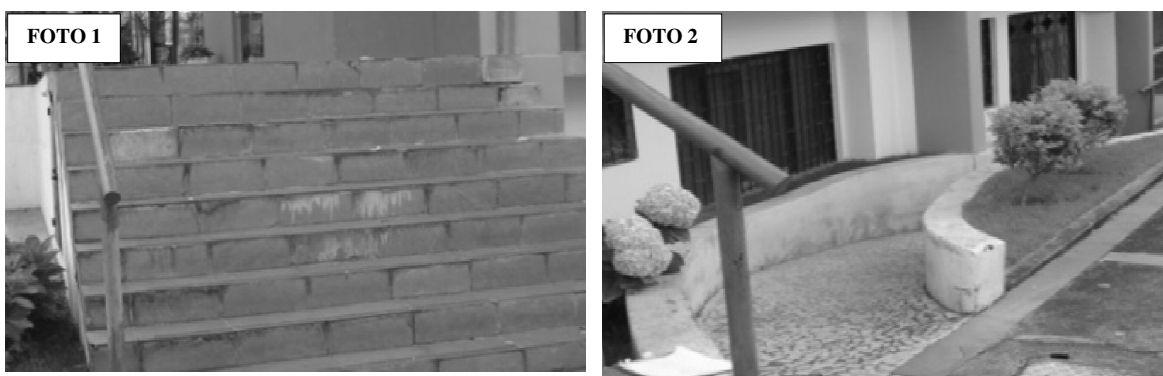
Foto 1, Escada 407NEE4; Foto 2, Rampa 407NER1
